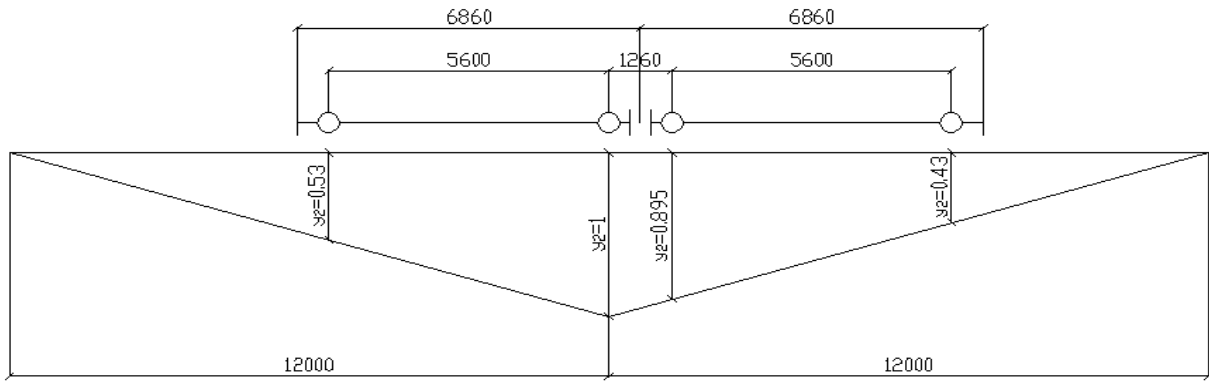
Схема к расчету колонны на среднюю нагрузку
